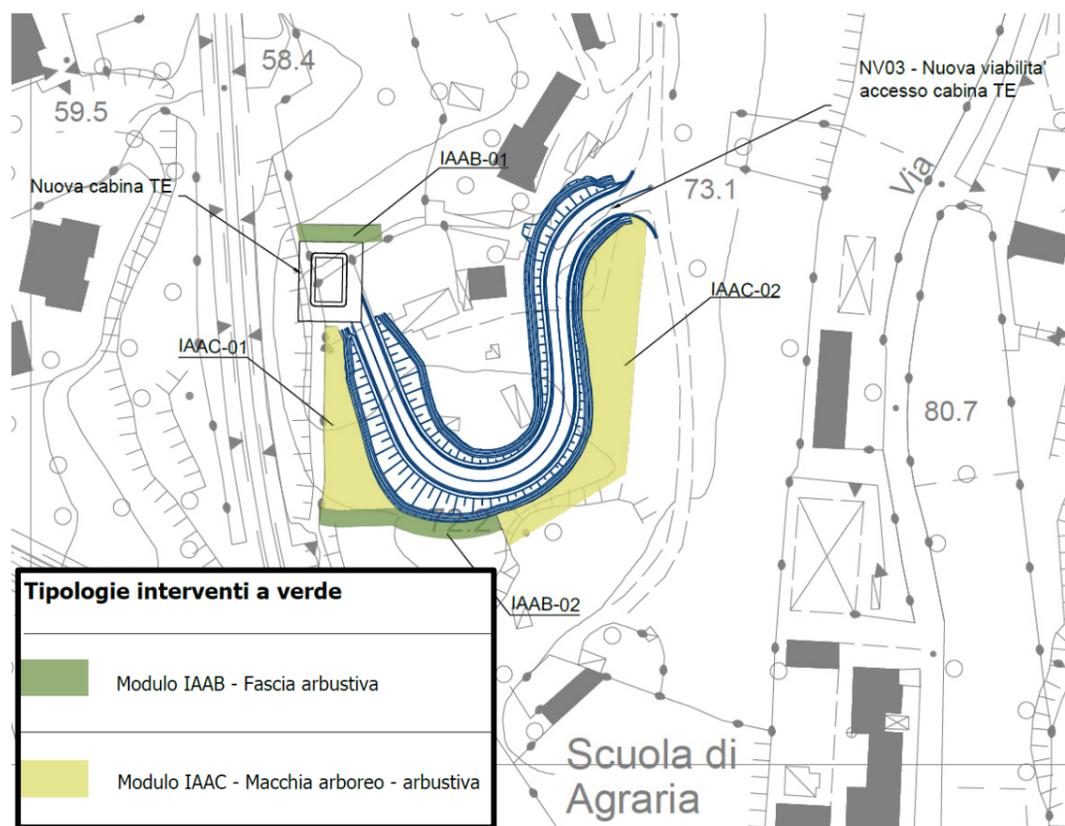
Stralcio Planimetria degli interventi di mitigazione
